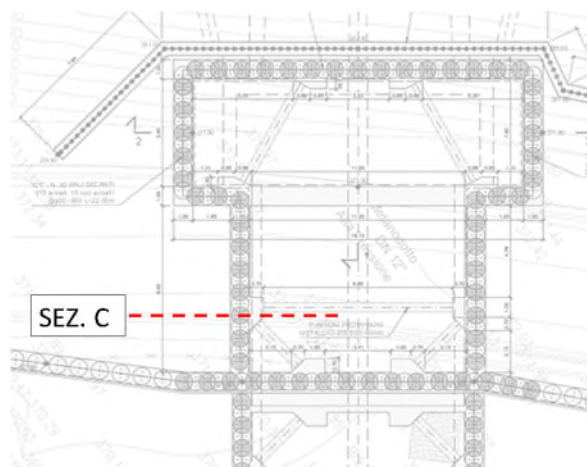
Pali tipo “D1” – Pianta e sezione
